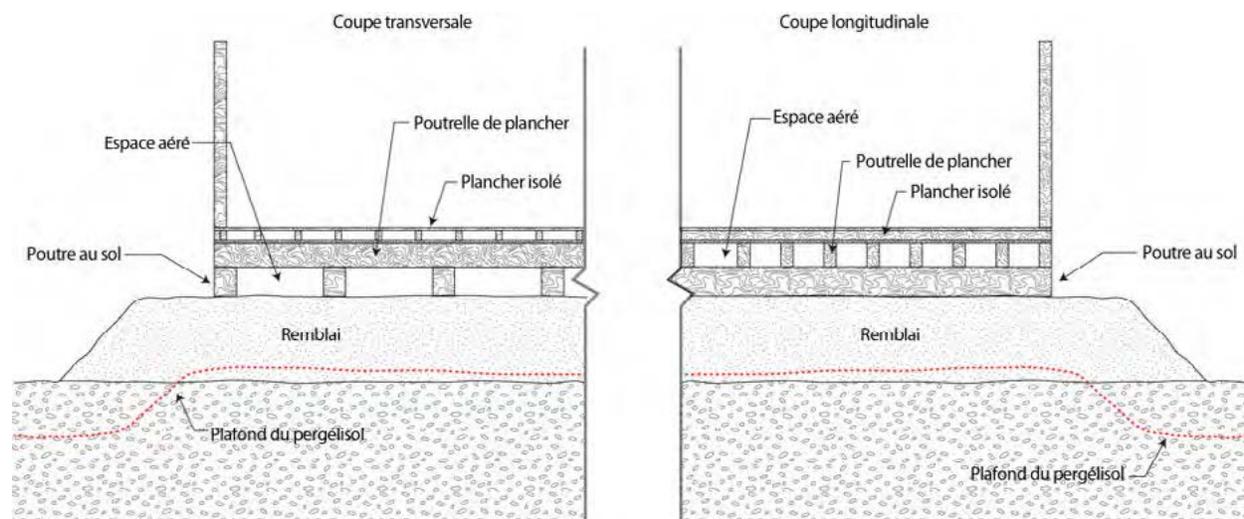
VUE EN COUPE TRANSVERSALE ET LONGITUDINALE D'UN CONCEPT DE FONDATION SUPERFICIELLE AVEC POUTRES AU NIVEAU DU SOL SUR REMBLAI GRANULAIRE.
